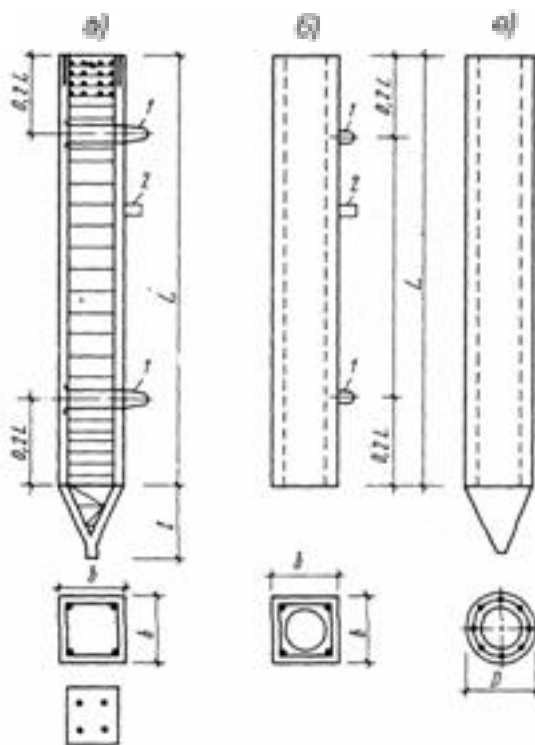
Железобетонные сваи: а – квадратного сплошного сечения; б – квадратного сечения с круглой полостью; в – полого круглого поперечного сечения.
